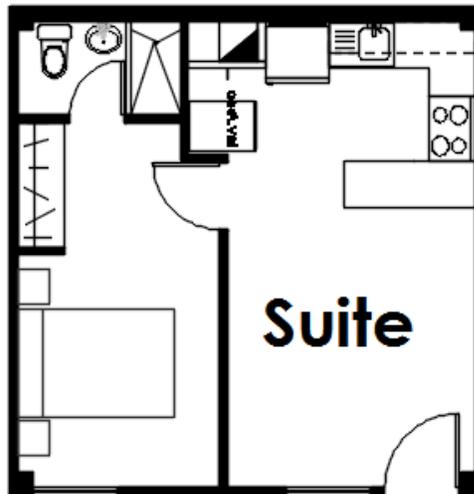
Planta arquitectónica Suite conjunto residencial "Praderas de Bemani".
